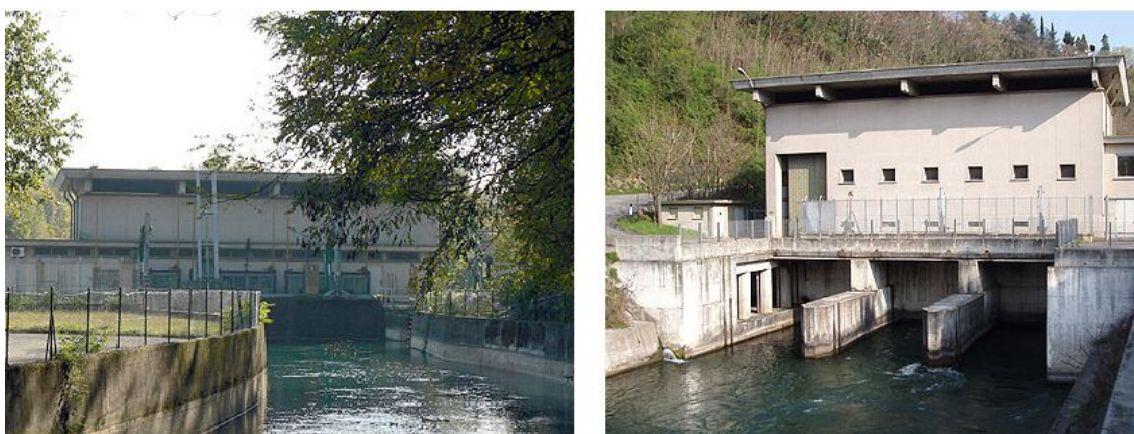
Opere di derivazione e restituzione dell'impianto
